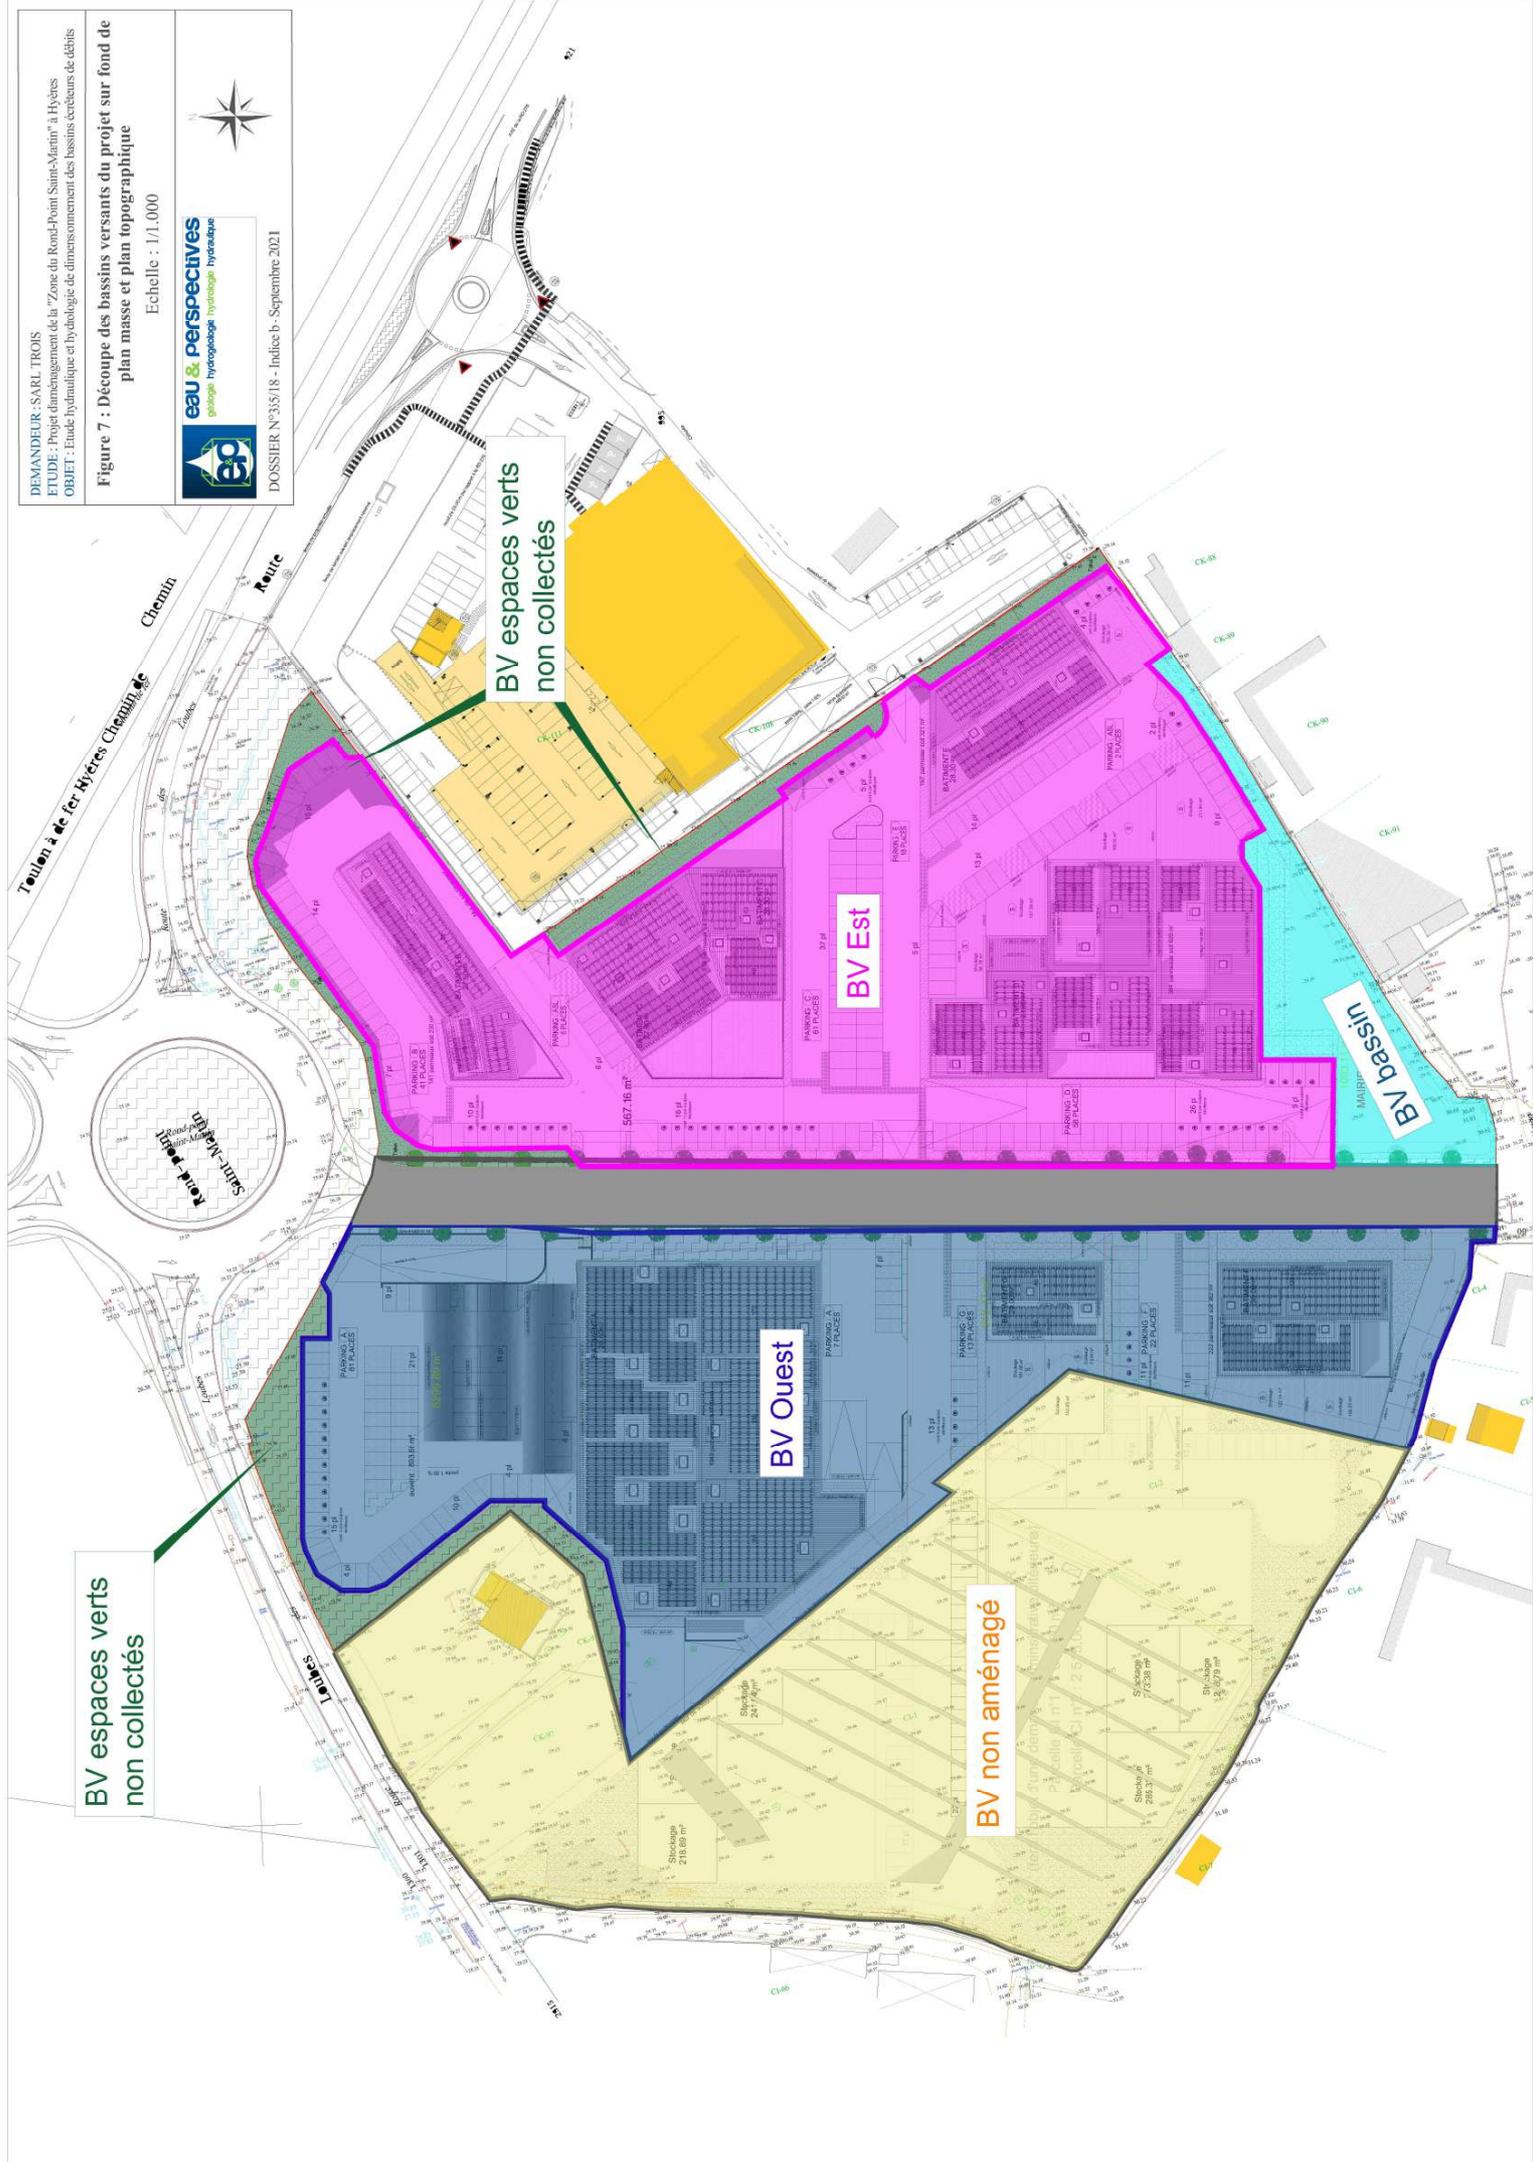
Découpe des bassins versants du projet sur fond de plan masse et plan topographique
